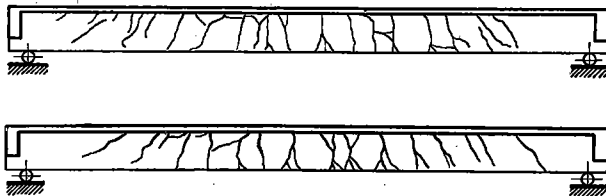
Apparition des fissures dans la dalle et les poutres à l'essai jusqu'à la rupture sur le modèle II.
